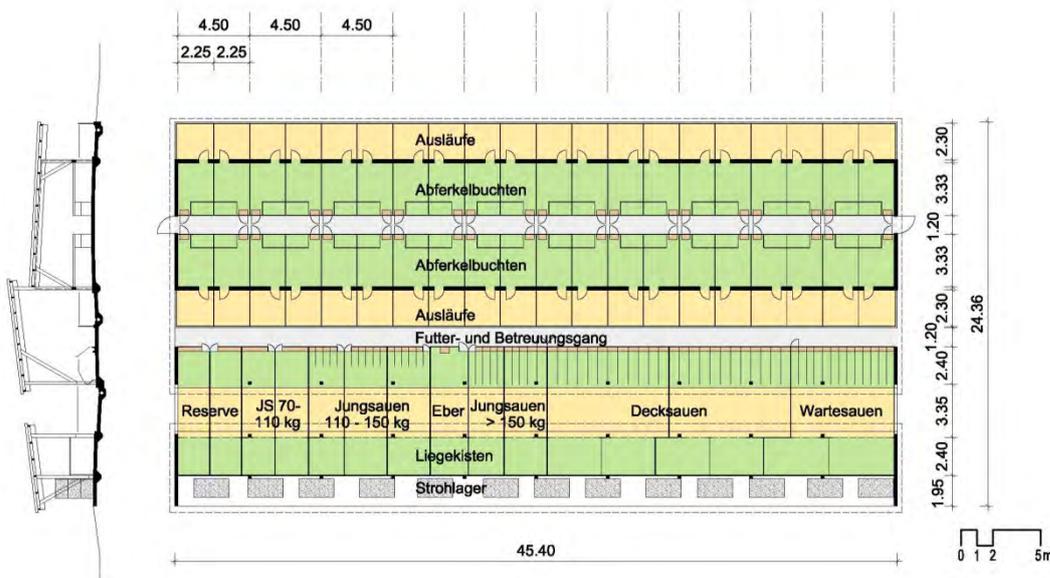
Grundriss und Schnitt des Kompaktstallabteils MODELL II mit innenliegender Fütterung
